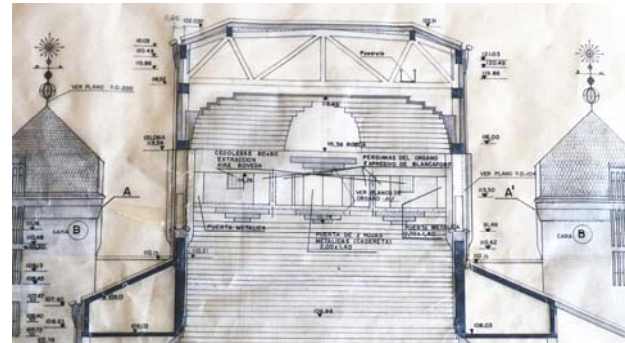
Sección transversal. Vigas cajón en parte baja y cercha de hormigón como sustento de cubierta y de la bóveda de ladrillo. Archivo de Heliodoro Dols Morell.
